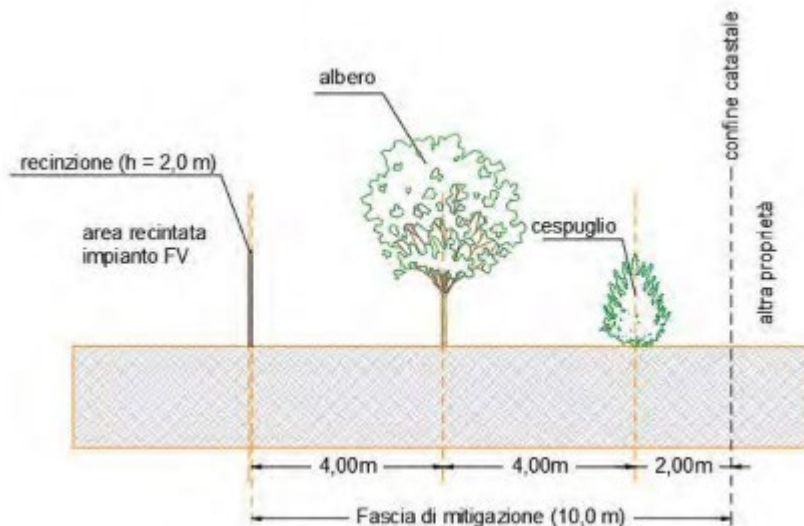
Stralcio di sezione dell'area perimetrale dell'impianto con la fascia di mitigazione
